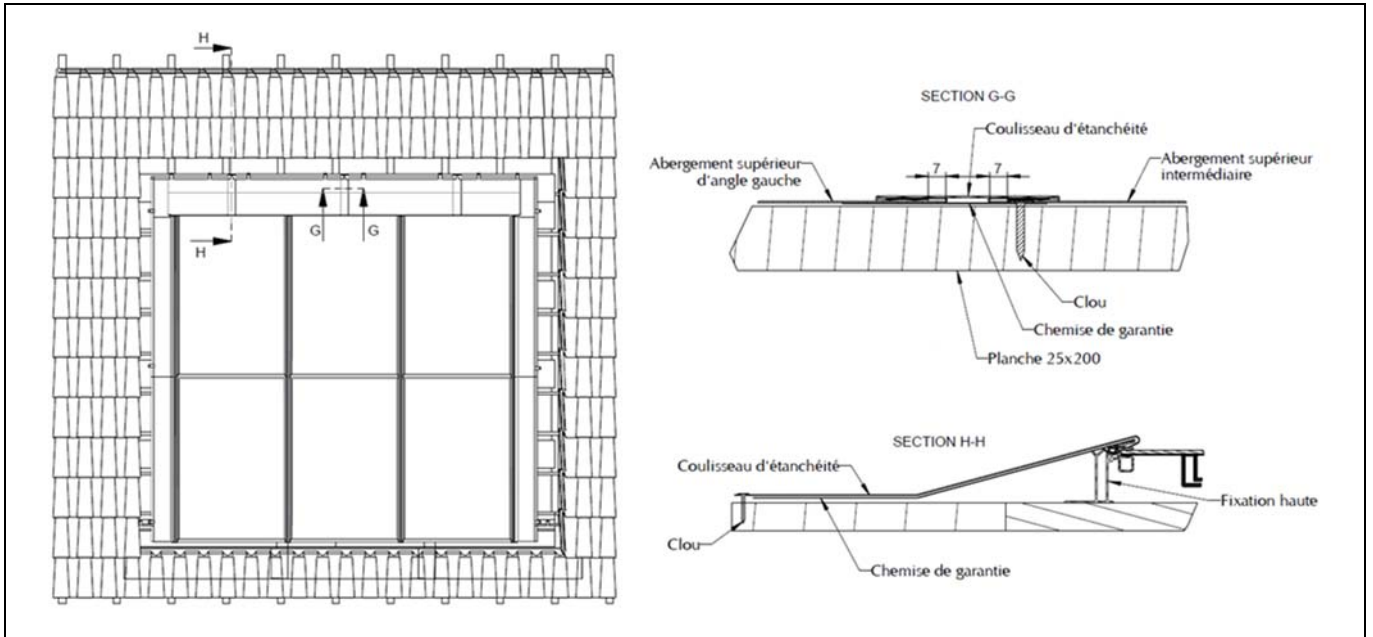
Pose des coulisseaux pour installation sur toiture ardoise
